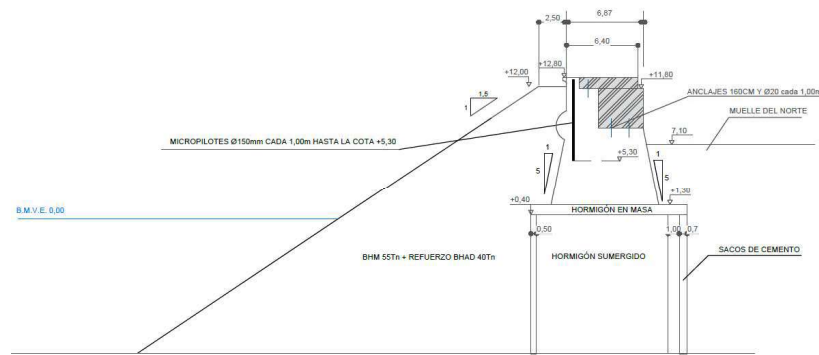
Sección tipo del tramo 1 de la alternativa 1. Fuente: elaboración propia
